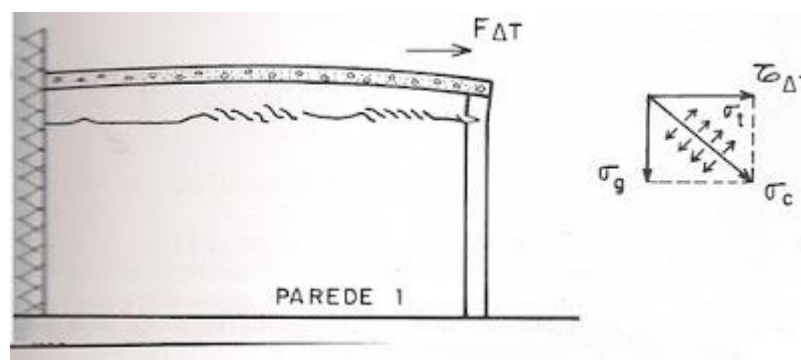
Fissuras causadas por dilatação térmica da laje de cobertura que induz tensões cisalhantes à alvenaria.
